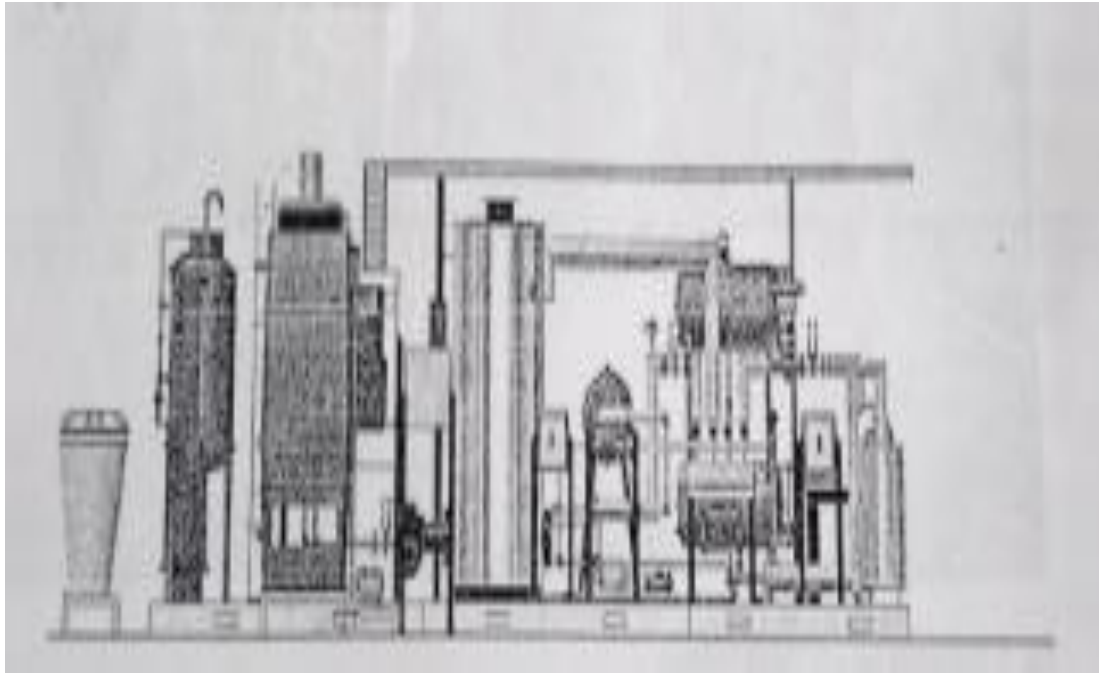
Vista frontal planta térmica piloto Universidad ECCL. [60]
